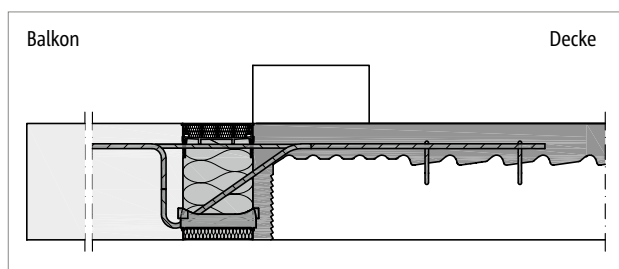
Schöck IDock®: Überzug am Deckenrand; Betonierfuge an der Oberkante der Decke
